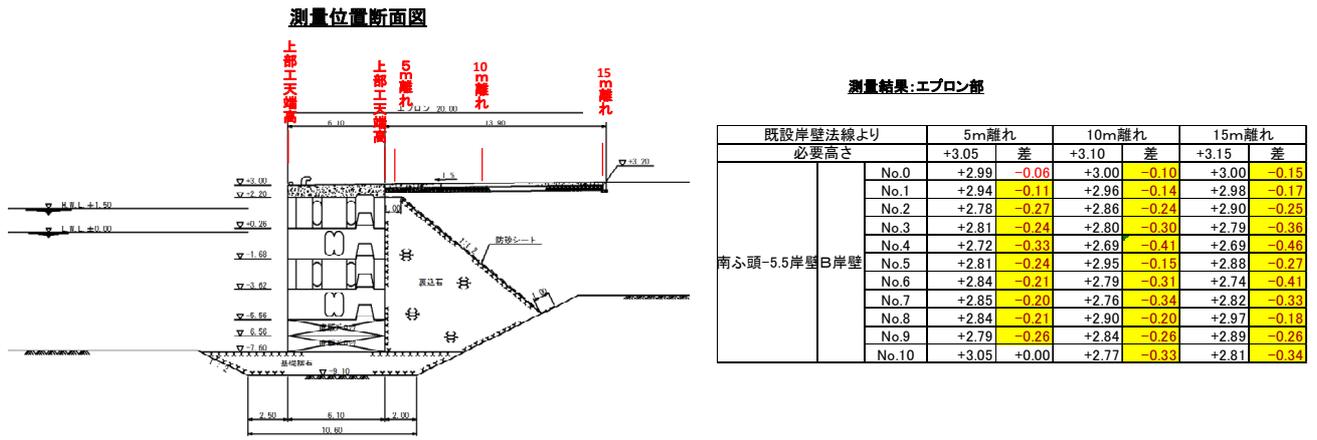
No.22 常陸那珂港区_南埠頭地区 B岸壁 (-5.5m) の断面図 (被災後)
